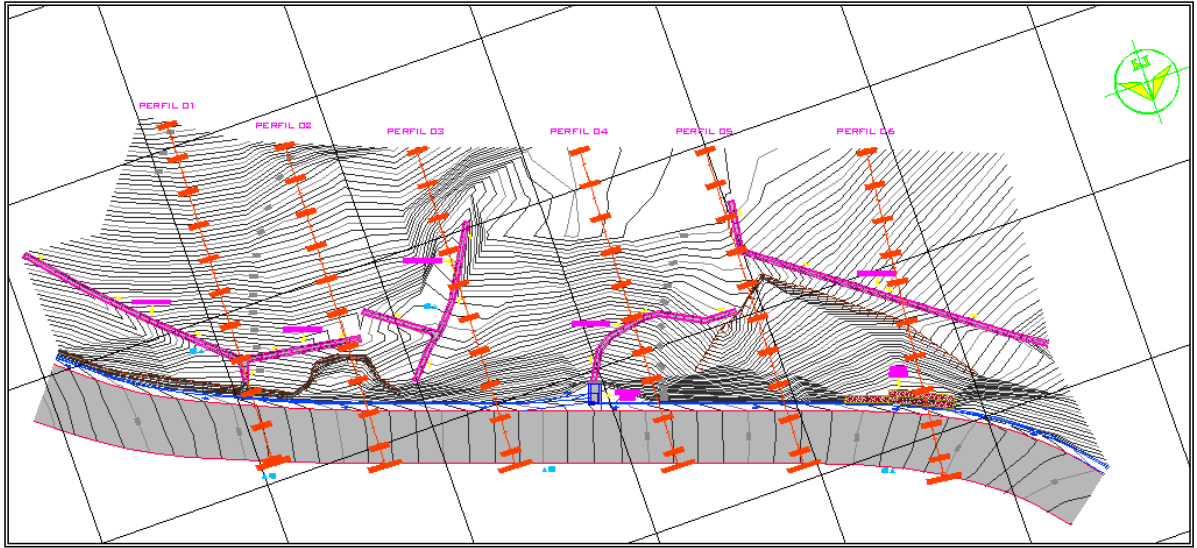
Levantamiento topográfico y detalle de canaletas existente
